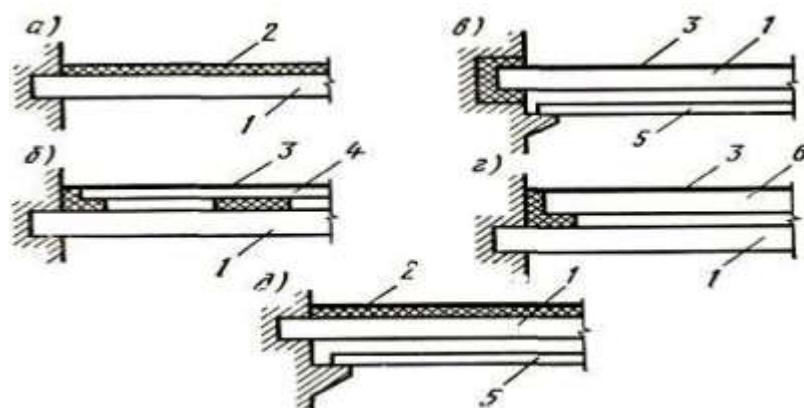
Конструктивные схемы перекрытий: а) со слоистым покрытием пола, б) с раздельным полом, в) с раздельным потолком, г) раздельное перекрытие из двух несущих панелей, д) с раздельным потолком и слоистым покрытием пола. 1 – несущая панель перекрытия, 2 – теплый слоистый пол, 3 – покрытие пола, 4 – панель основания раздельного пола, 5 – панель раздельного потолка, 6 – несущая панель пола
